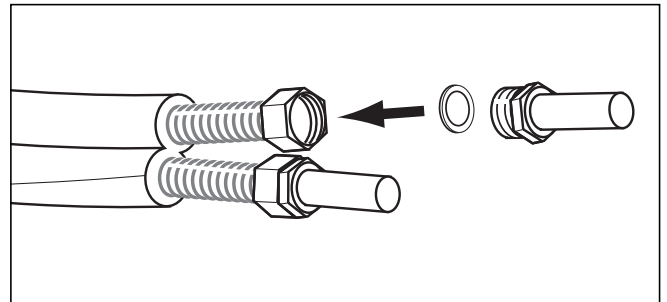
Poser la bague d'étanchéité et monter le raccord G 3/4" sur la vis de serrage 18 mm.
